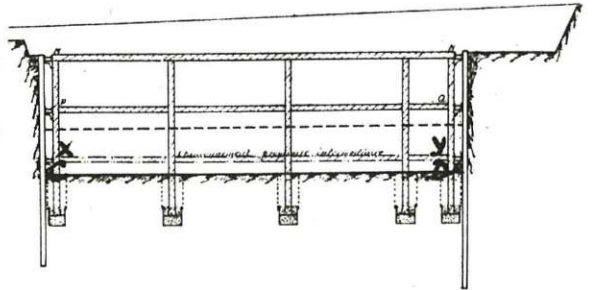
a) Approfondissement de la fouille jusqu'en C D; b) Pose d'un poutrage d'étaisonnement provisoire intermédiaire en X Y.
